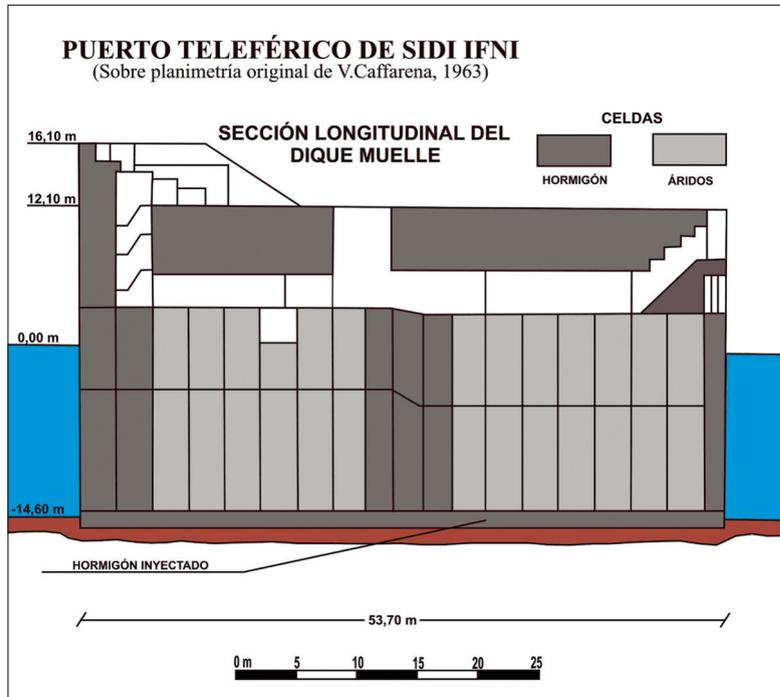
Plano del dique muelle realizado en Sidi Ifni (sobre planimetría original, Caffarena 1963:64).
